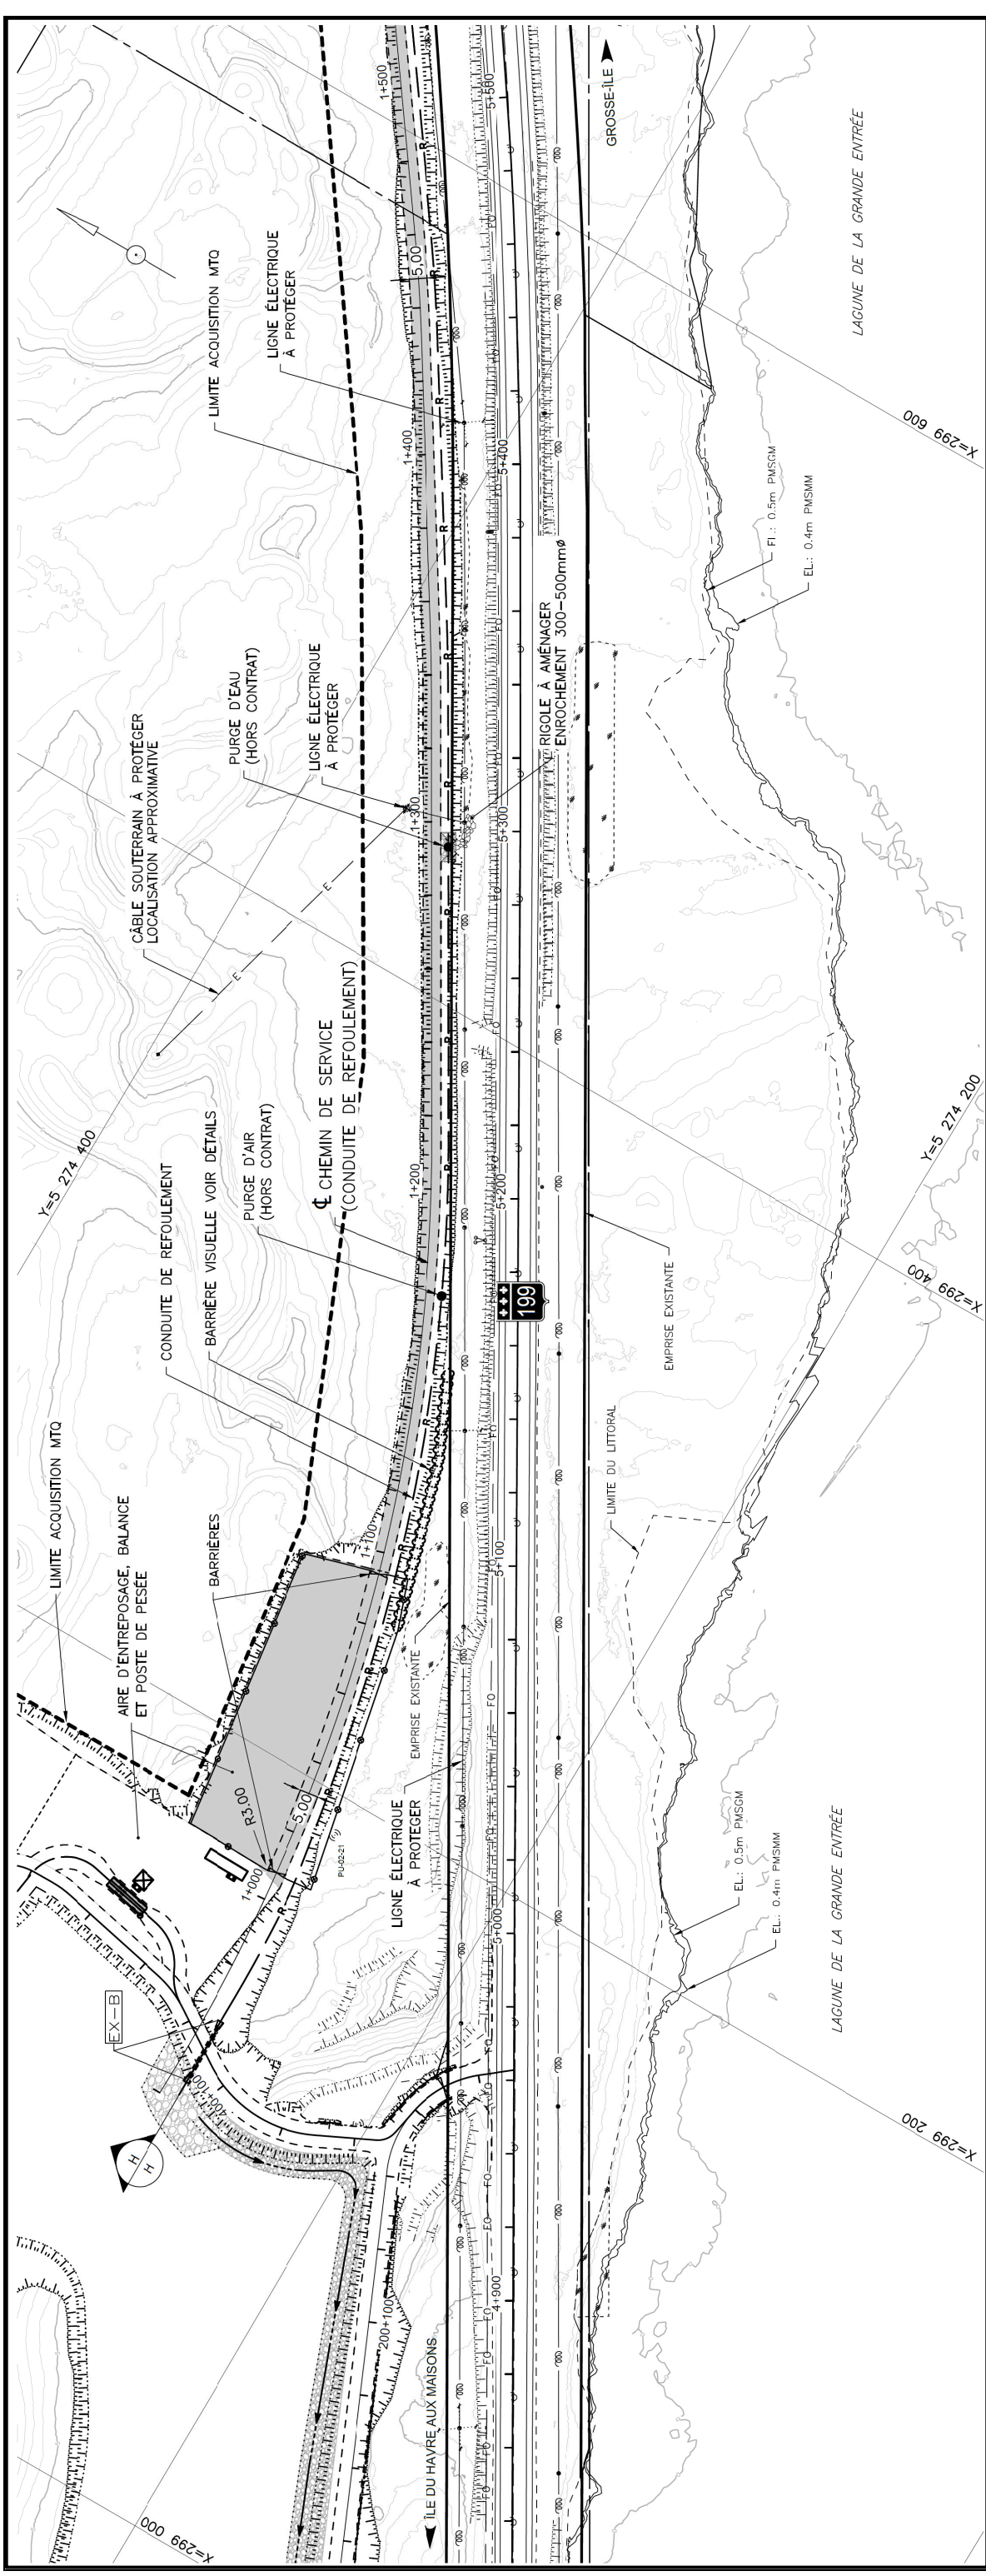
Plan préliminaire du tracé de la conduite de refoulement – Secteur de l'aire d'entreposage du MTQ
